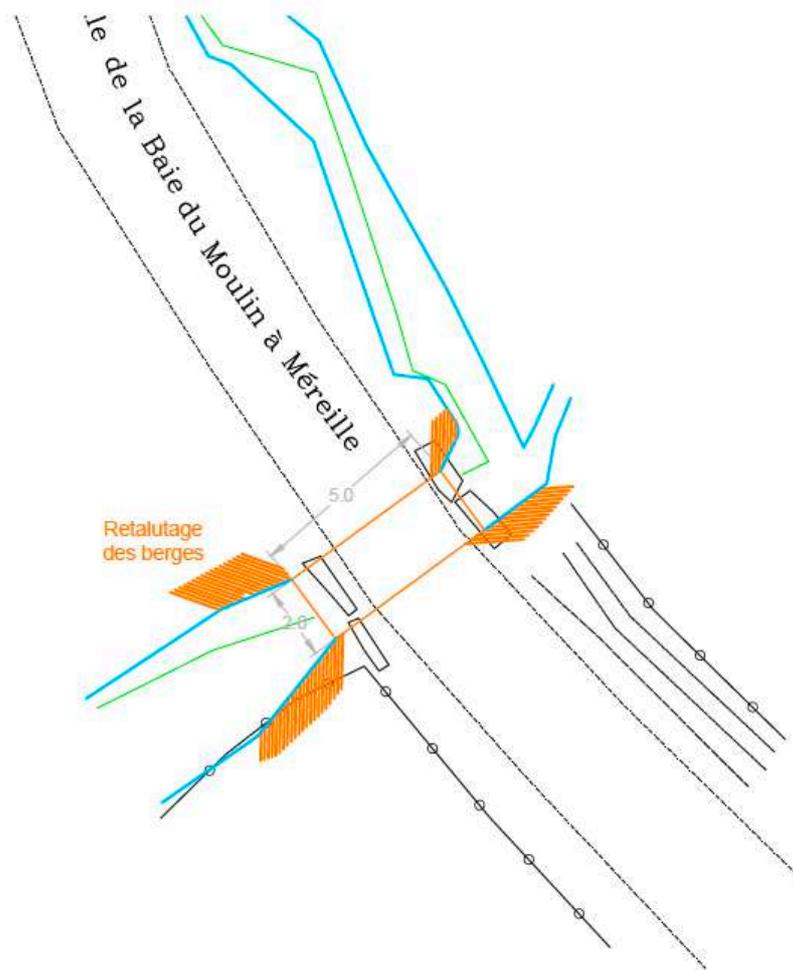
Vue en plan de l'aménagement de l'ouvrage ROE 114198
